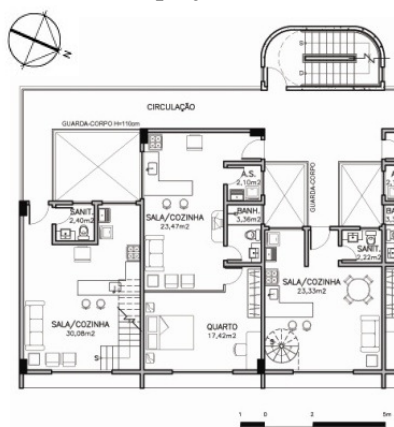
Planta do Pavimento Tipo do Bloco 2. Fonte: FANTICELE; ALVAREZ, 2008.
